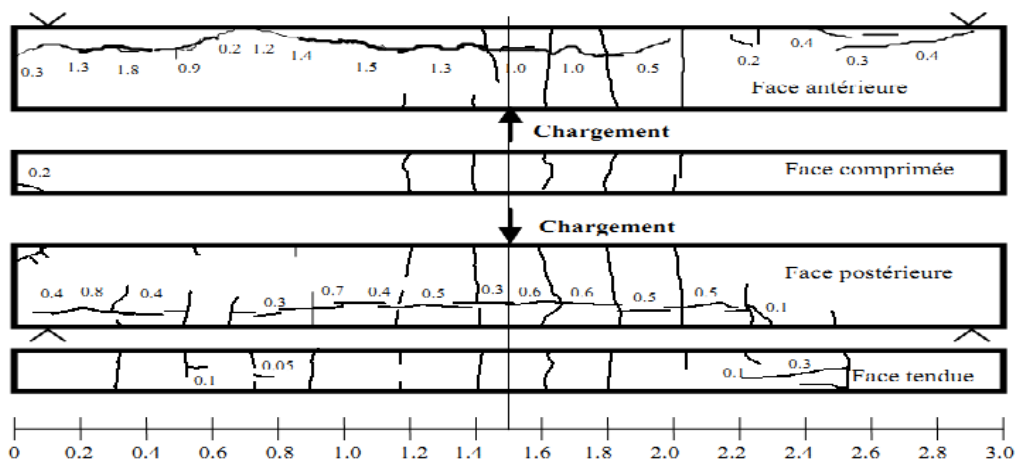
Carte de fissuration à 17 ans de la poutre A1C11 avec les ouvertures des fissures de corrosion en mm.
